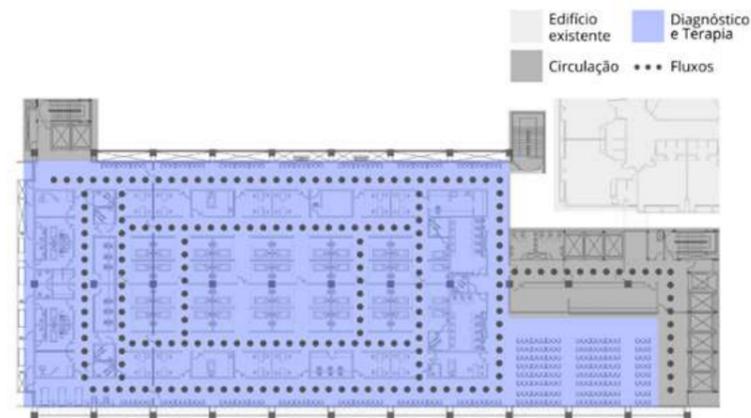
Setorização do projeto de ampliação - 3º pavimento
